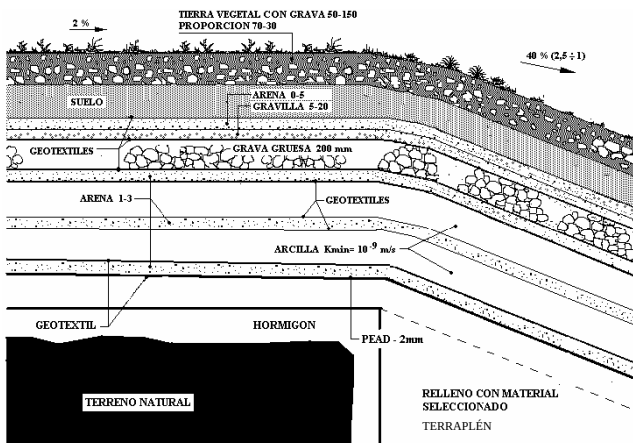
Vista en sección de las capas que constituyen la cobertura de ensayo I.
